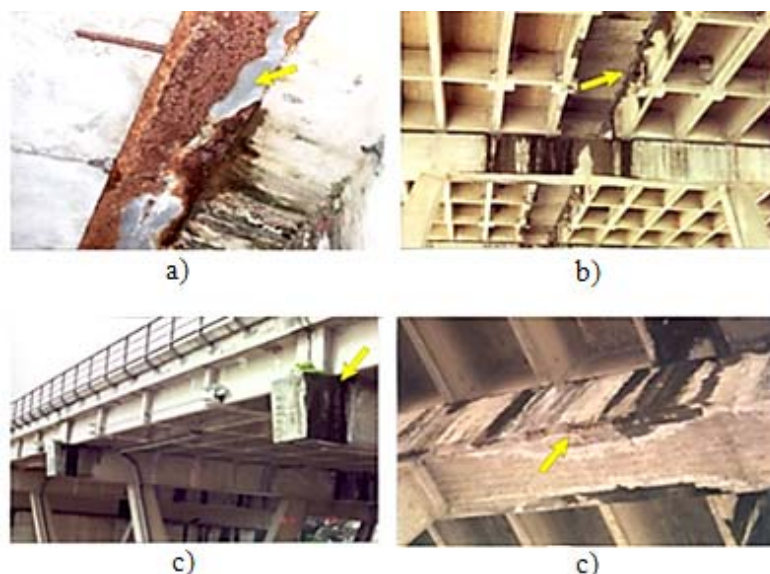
Infiltrações de água no tabuleiro: a) Corrosão do perfil de apoio da laje do Separador Central; b) Infiltração na laje do Separador Central; c) Infiltração e deterioração nas Travessas dos Pilares (Brisa, 2002a).
